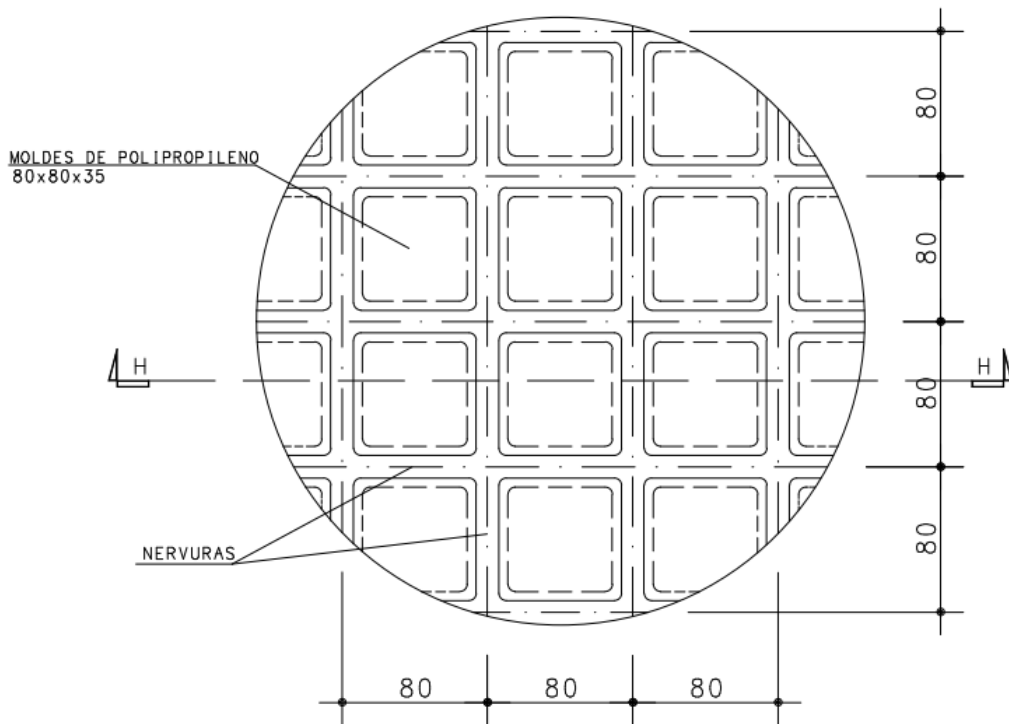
Laje nervurada em planta – Detalhe Genérico. (TQS, versão 2021).
